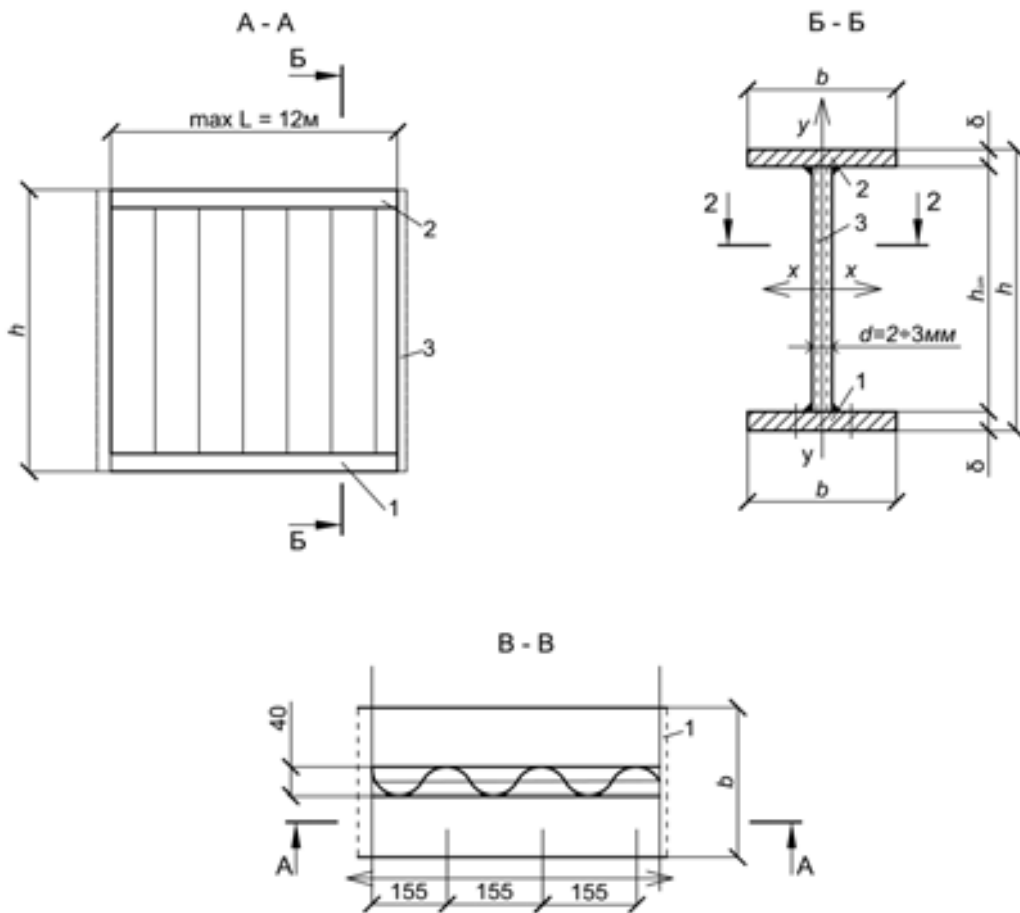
Схема стальной балки с гофрированной стенкой: сечение А-А – продольный разрез; сечение Б-Б – поперечный разрез; сечение В-В – план стальной балки (без огнезащиты): 1 – растянутая полка; 2 – сжатая полка; 3 – гофрированная стенка; h и b – высота и ширина сварного двутавра стальной балки; d – толщина гофрированной стенки, мм; δ – толщина полки стальной балки, мм
